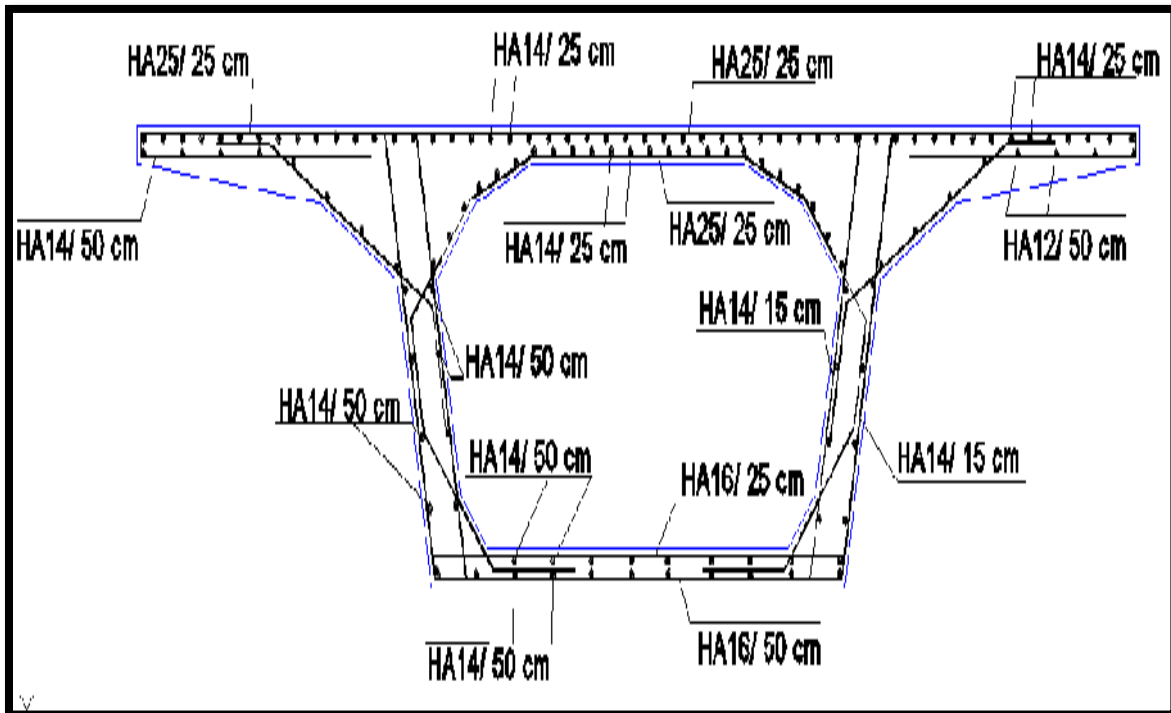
Ferrailage du voussoir à la clé.
